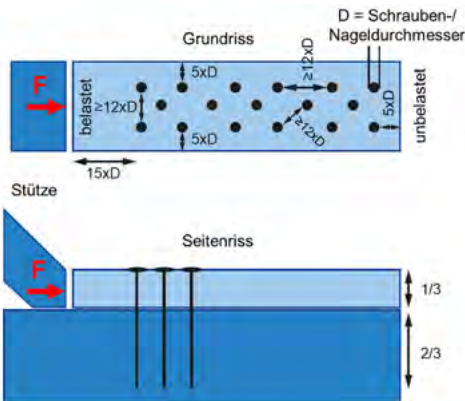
Nagelbild einer Knagge (Blockhaus, THW)
